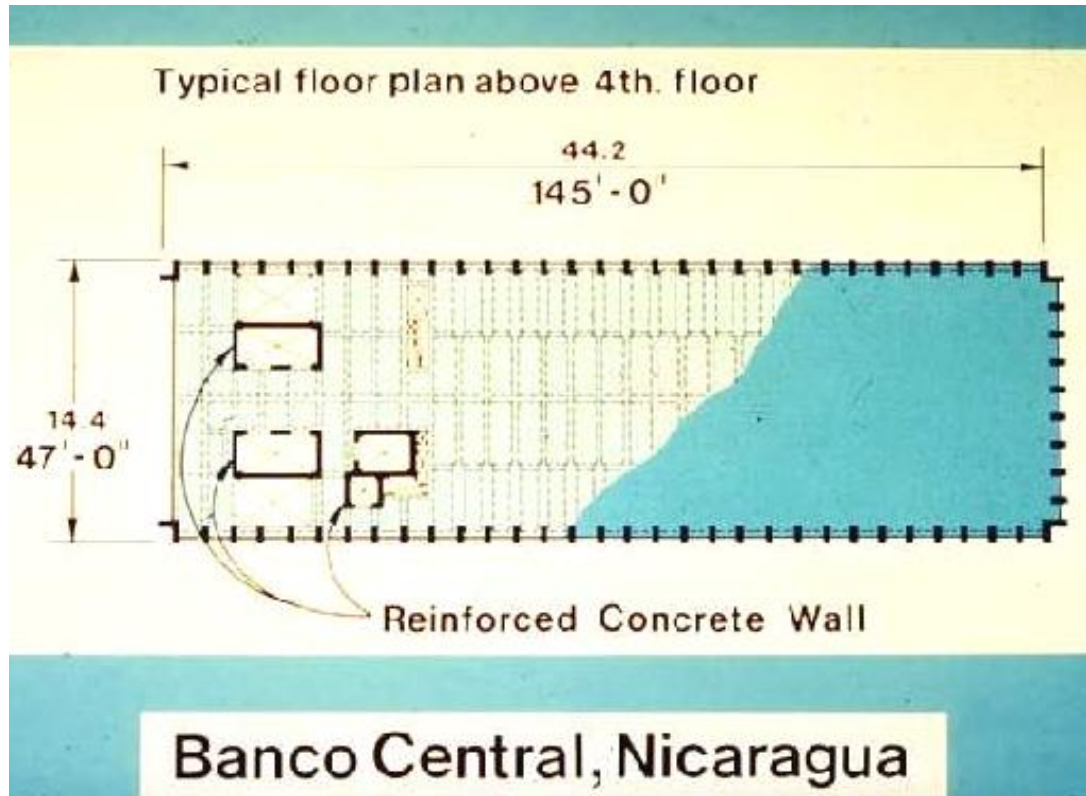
Plano con indicación de ubicación incorrecta de muros de corte del Banco Central en Nicaragua.
